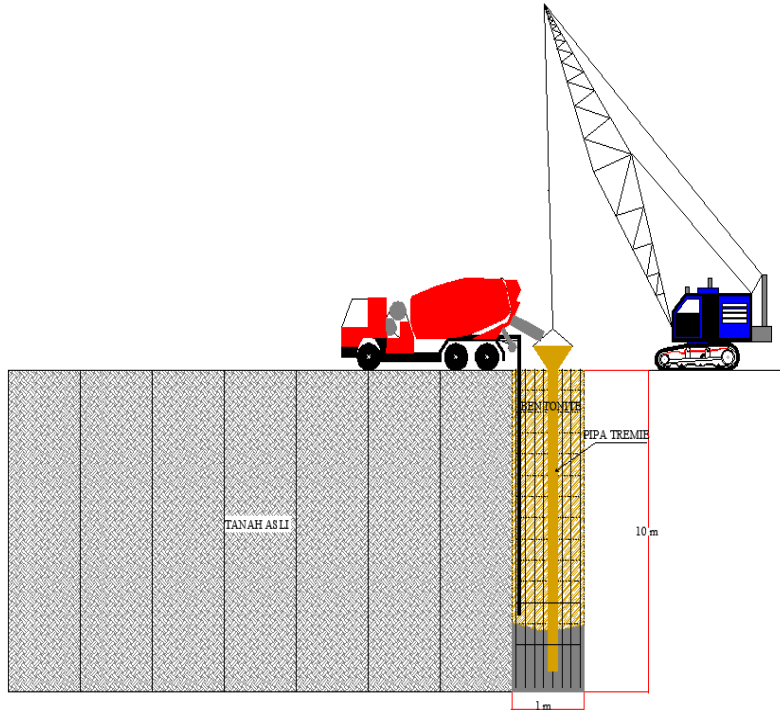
Penggalan Tanah untuk diaphragm wall
